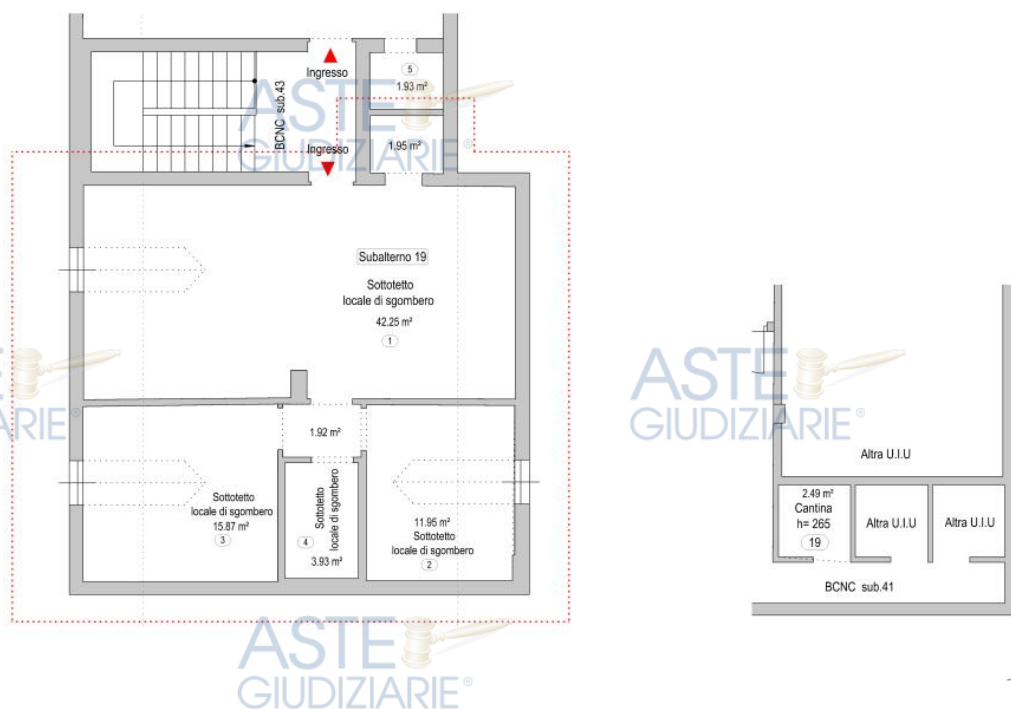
Planimetria subalterno n. 19 (piano secondo e piano interrato). Si rimanda all'Allegato A per elaborato in scala
